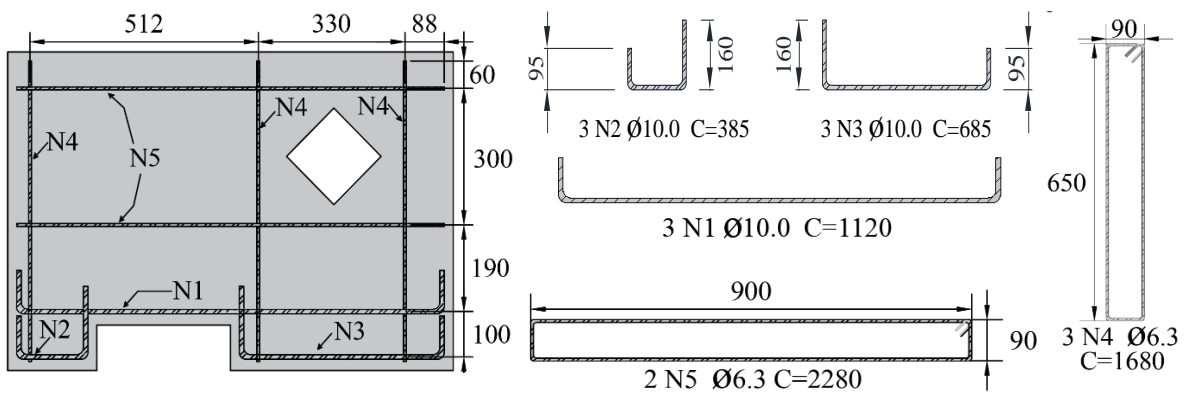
Detalhamento das armaduras DB2-W-H1-U-A (dimensões mm)
